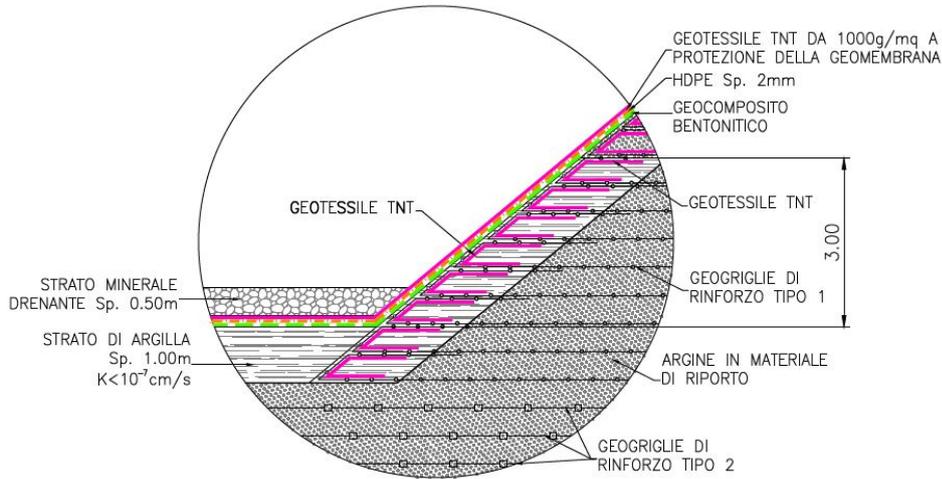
Particolare "A2" – Barriera di protezione sul fondo
